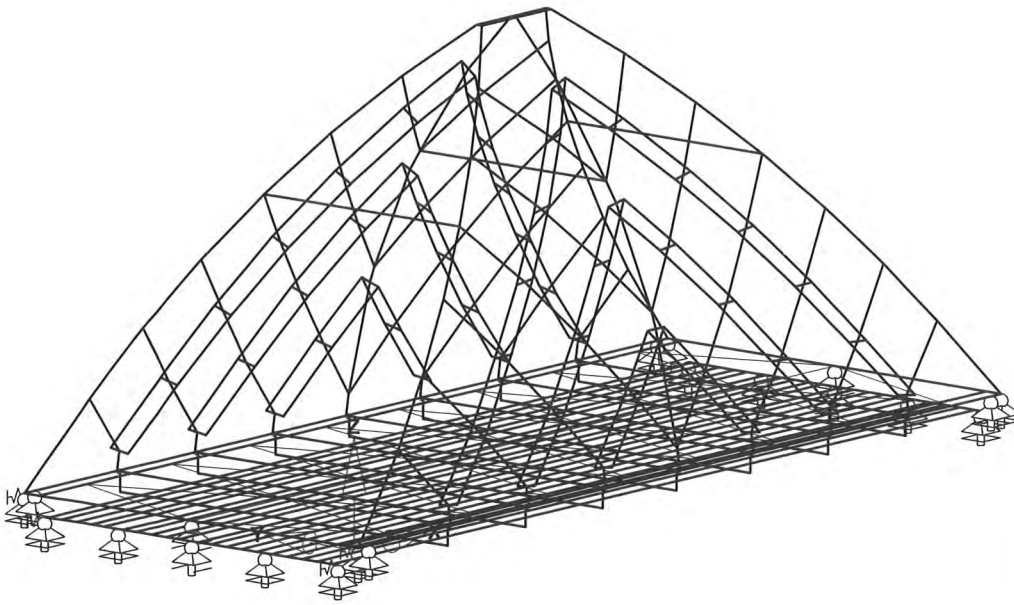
Stabwerksmodell der Fachwerkbrücke einschließlich Fahrbahn
